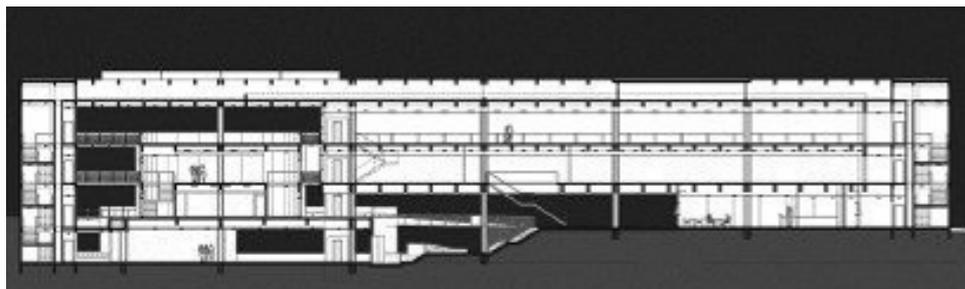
Corte longitudinal (MELENDEZ, 2008)
